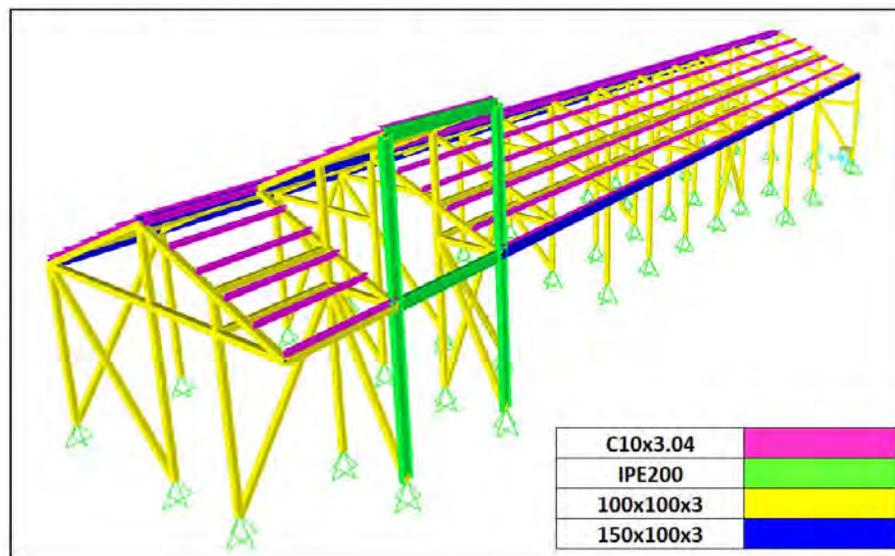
Vista 3D Modelo en SAP2000, Perfiles extruidos.
